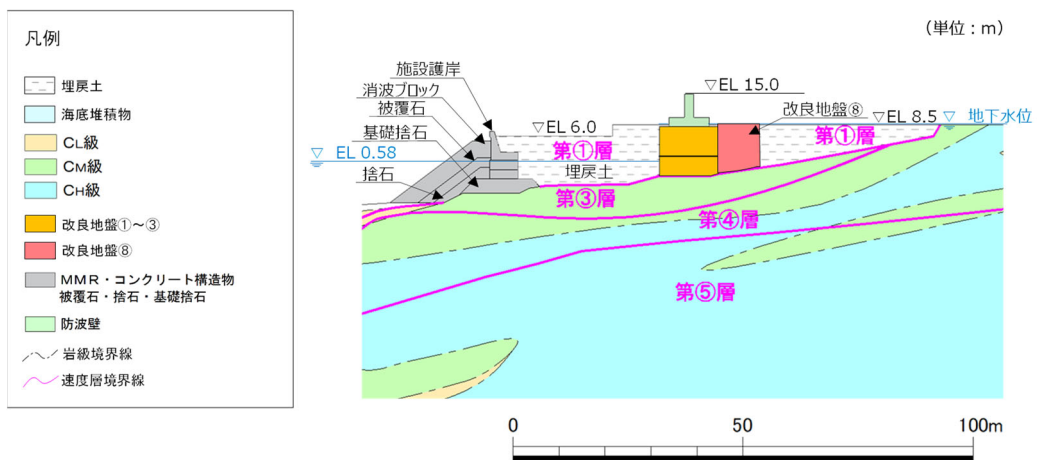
影響確認断面の地質断面図（①-①断面）
